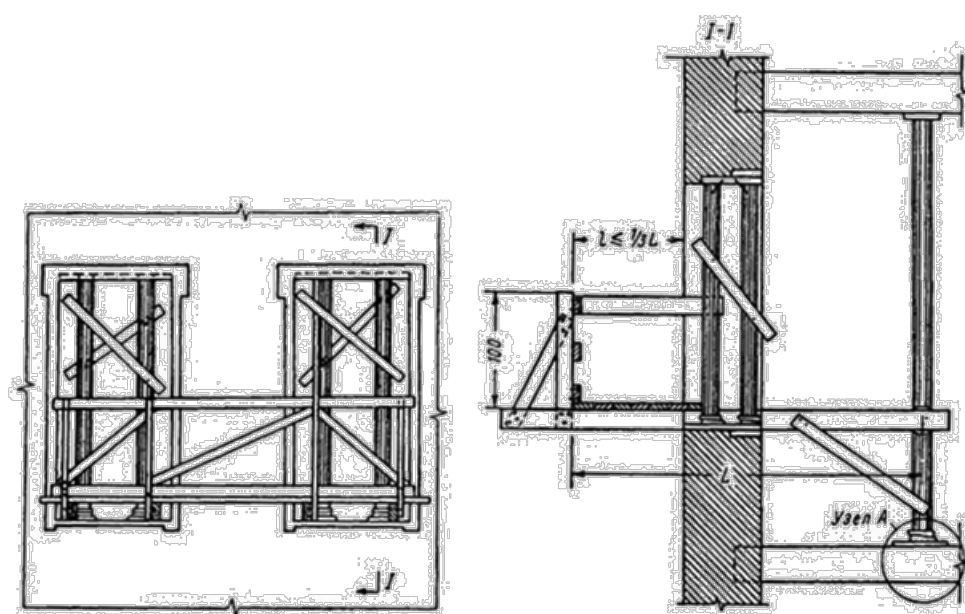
Схема устройства временных креплений перемычек и выпускных лесов при усилении кирпичных простенков
